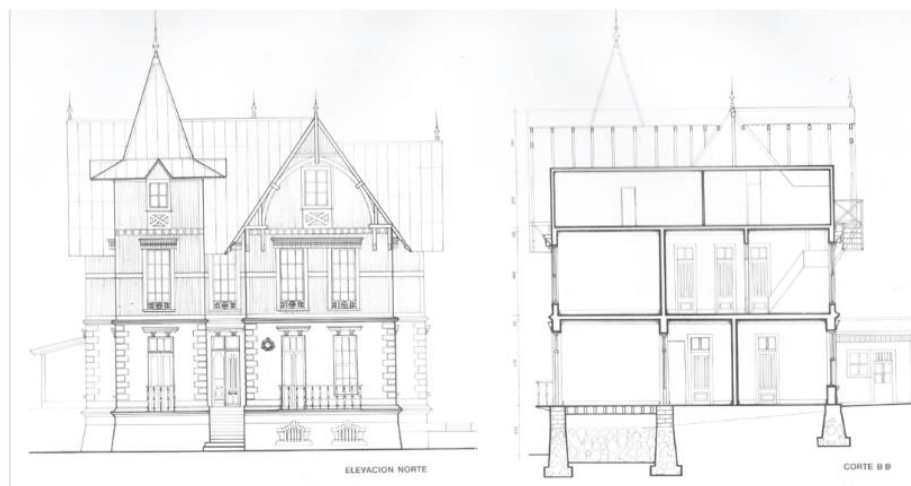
Casa Av Gran Bretaña 761. Los Entramados tradicionales de madera en los cerros Alegre y Concepción. Wasiberg M. (1988). *Casas de Playa Ancha*.
